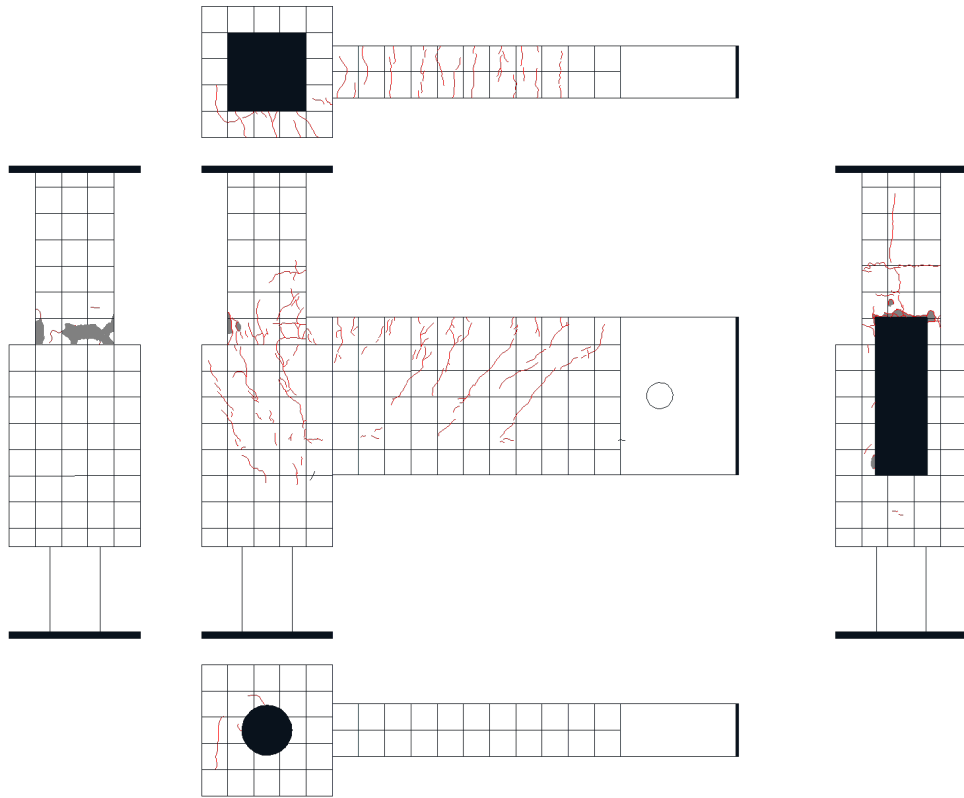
試験体 D-2 ひび割れ状況 (7Cycle)
